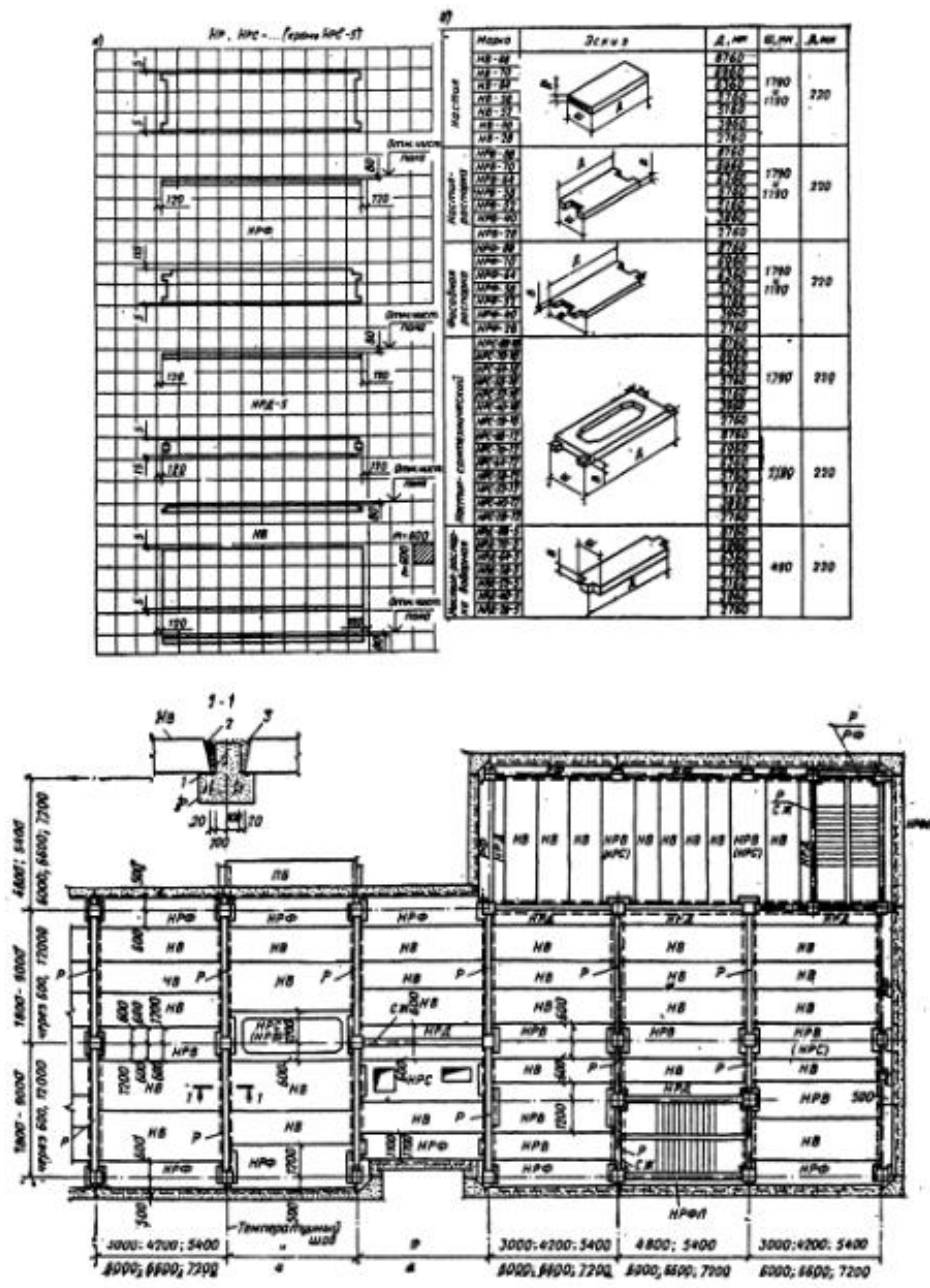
Фрагмент монтажной схемы элементов перекрытия и деталь (сечение а-а) температурного деформационного шва: НВ - настил; НРФ - настил-распорка фасадная; НРС - настил-распорка санитарная; НРД - настил-распорка доборная; НРФЛ - настил-распорка фасадная в зоне лестничной клетки; СЖ - стенка жёсткости, Р - ригель; РФ - ригель фасадный; 1 - стальная прокладка, обеспечивающая подвижное опирание панели перекрытия на ригель; 2 - юнопатка минеральным войлоком на цементном растворе; 3 - зачеканка цементным раствором до верха настила
